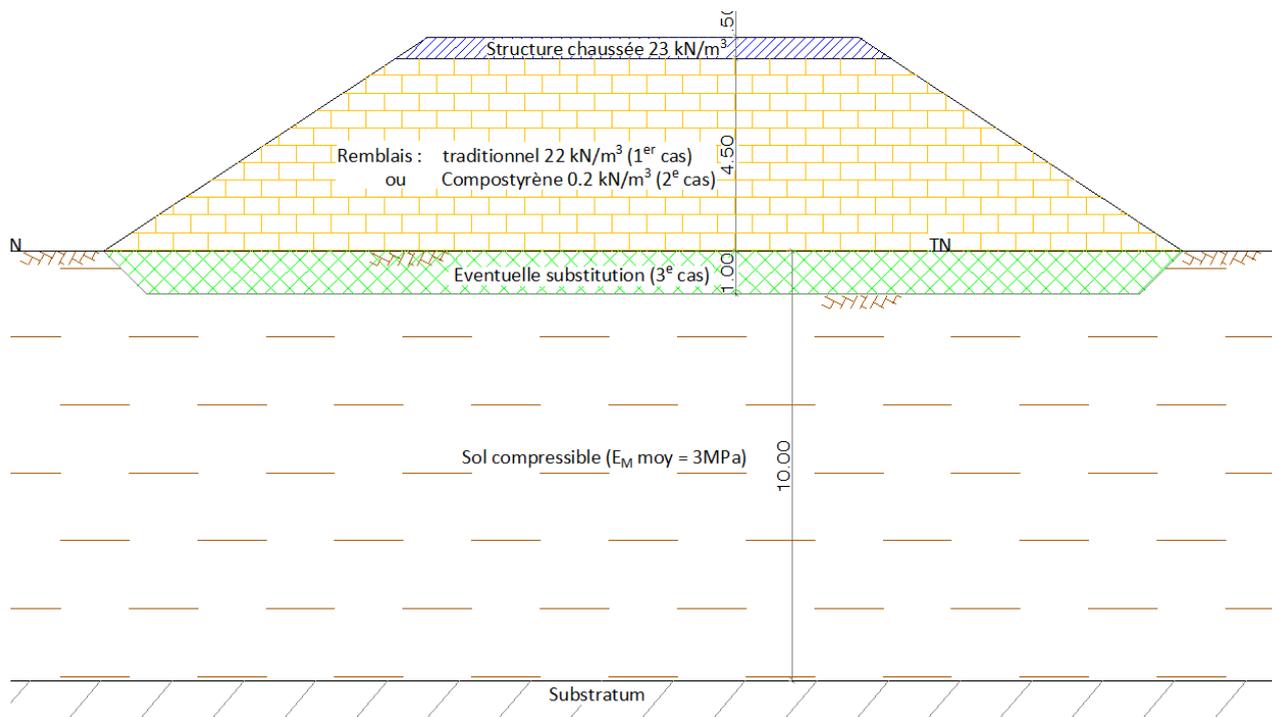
Exemple de construction d'une chaussée en remblai sur sols compressibles
